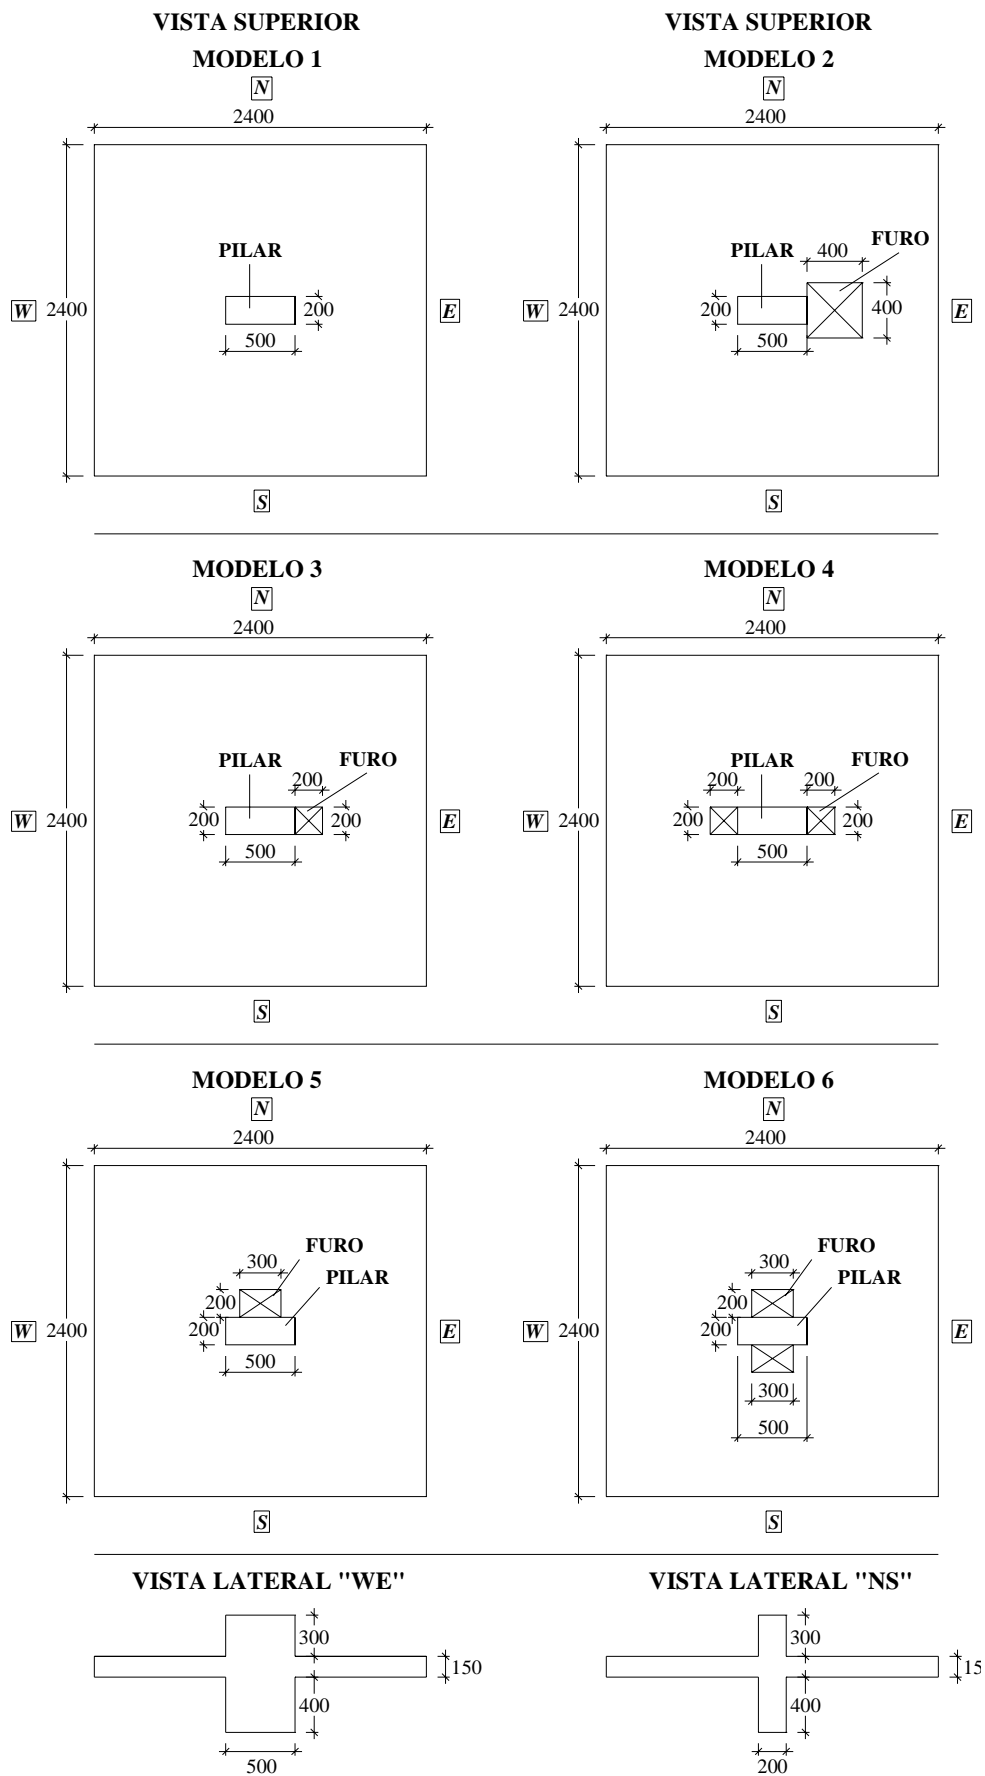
Características das lajes ensaiadas – Modelos 1 ao 6
